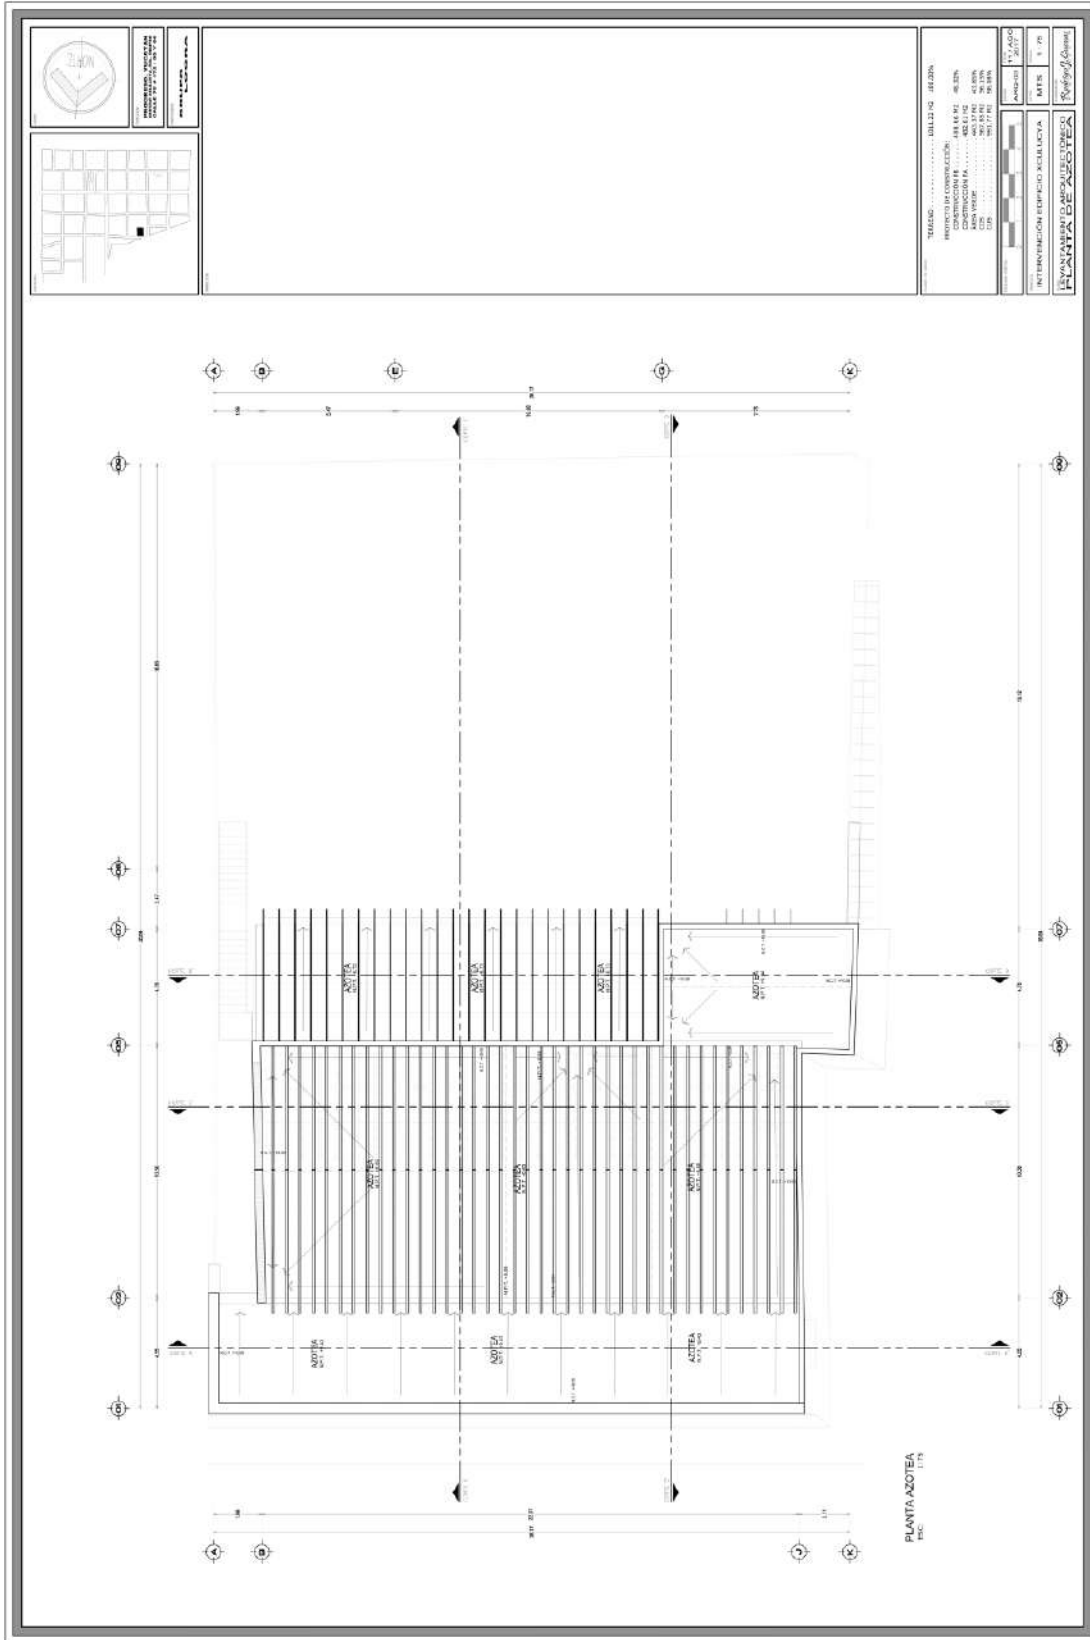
Proyecto arquitectónico de Museo/restaurante Xculucya – vista de conjunto. Fuente: Elaboración propia.
